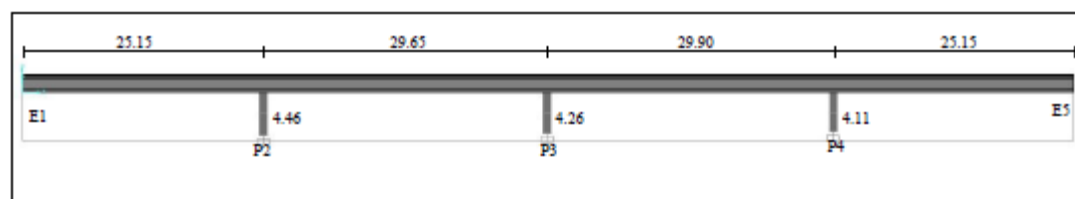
Elevación longitudinal del Puente Motín de Oro, Jara et al., 2009 (unidades en m)
